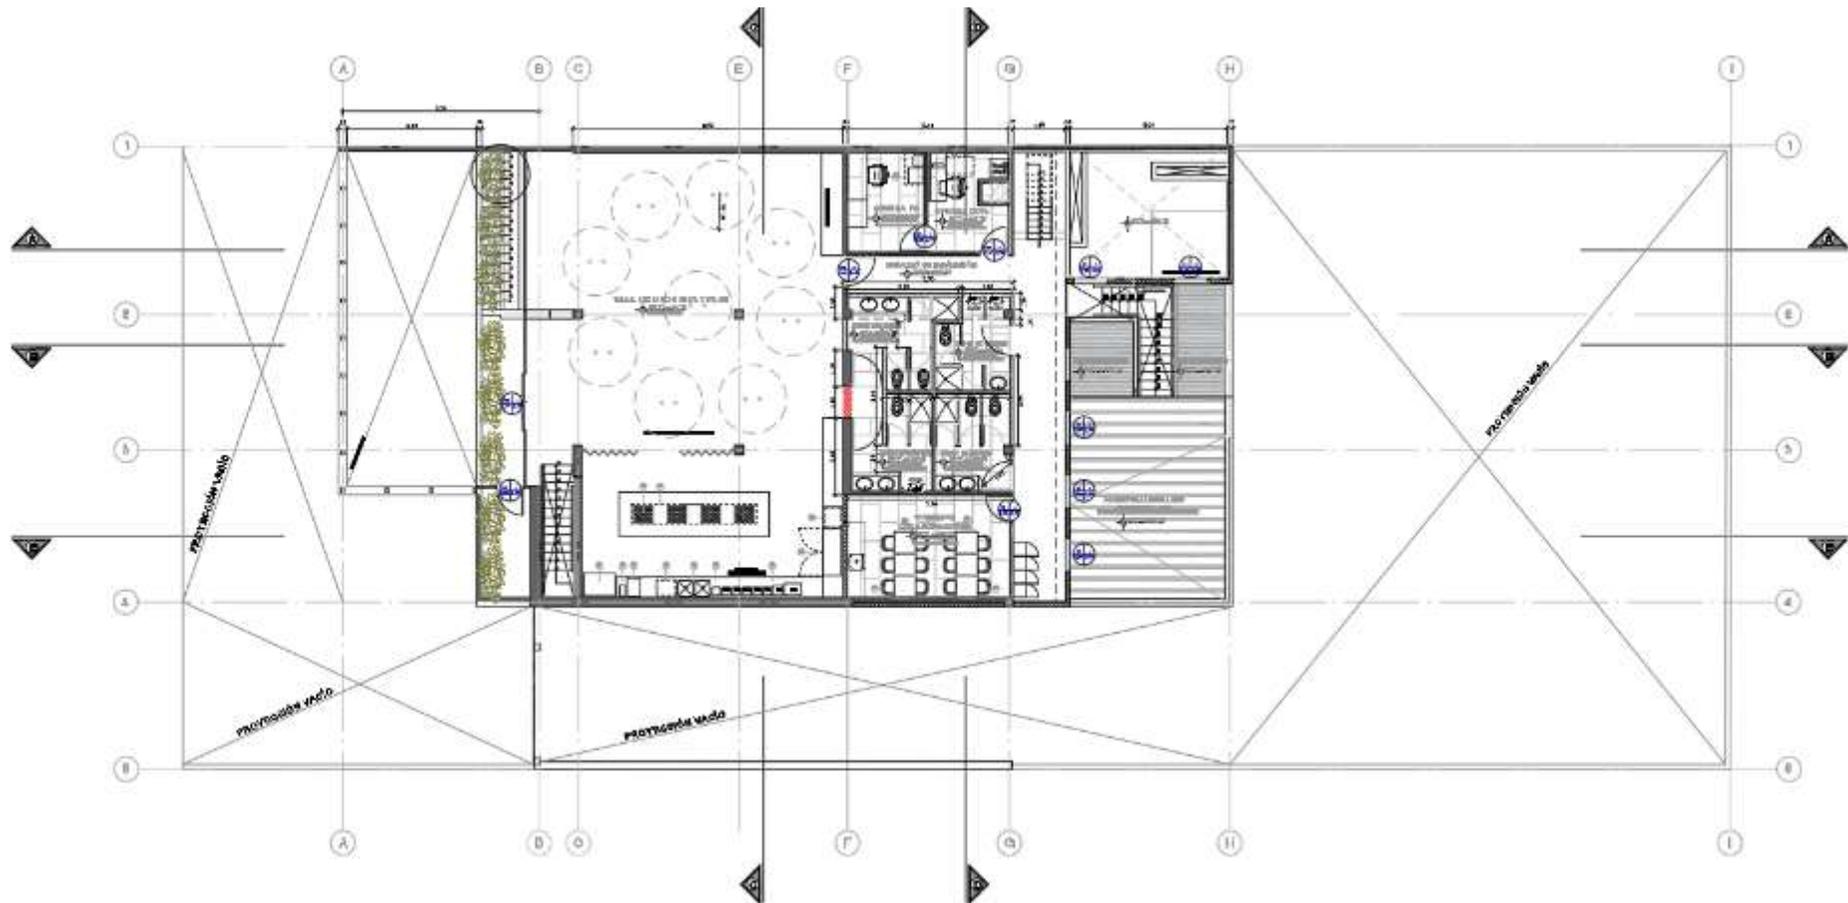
Plano general 2do piso Arquitectura - proyecto Tienda Saludable
